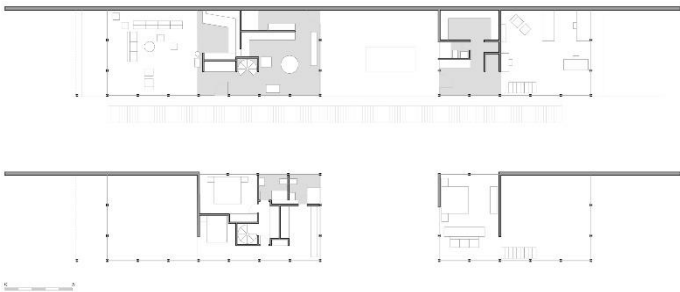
Planos de planta baja y primera de la *Eames House* redibujados
